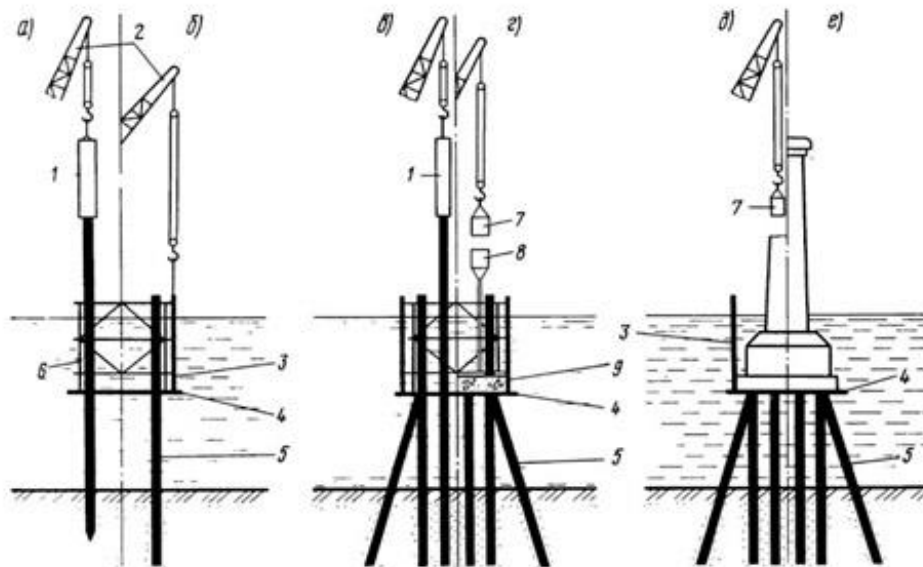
Послідовність будівництва пальового фундаменту з ростверком, розташованим над ґрунтом:
